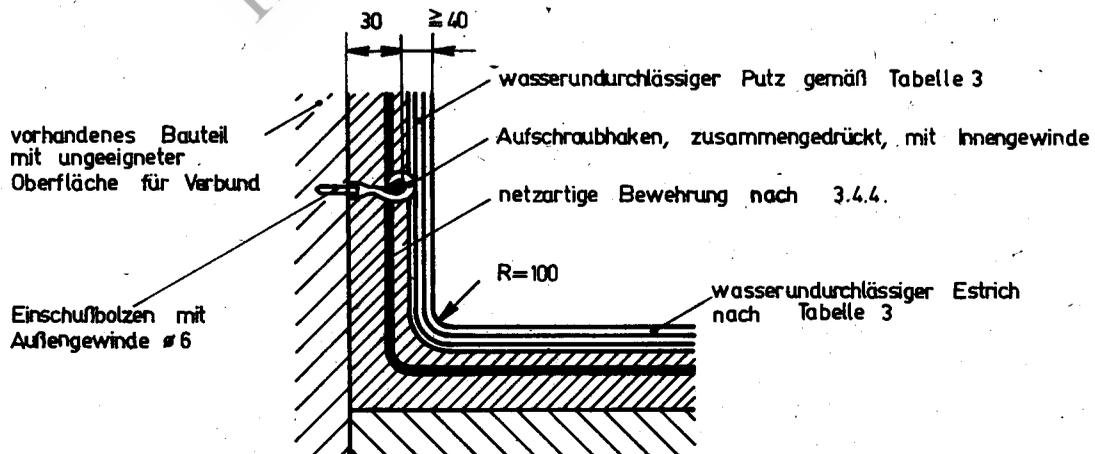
Innendichtung gegen Druckwasser von außen über 1m Höhe
